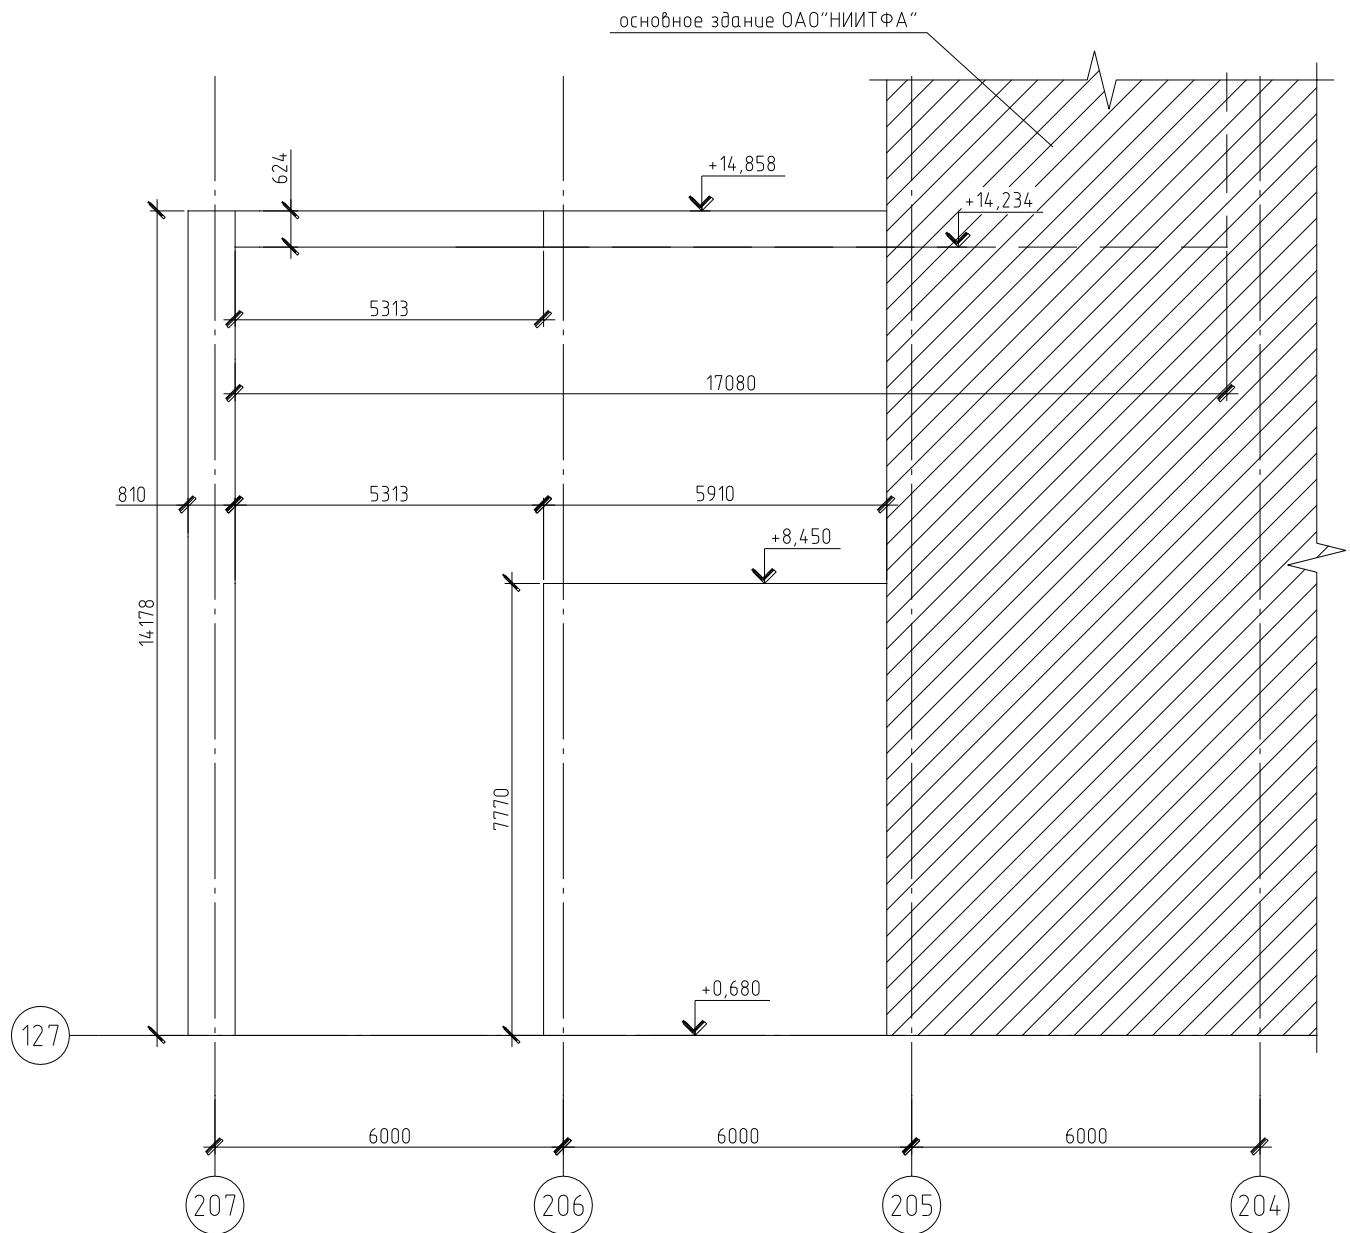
Фасад здания в осях «127/207-204» .
